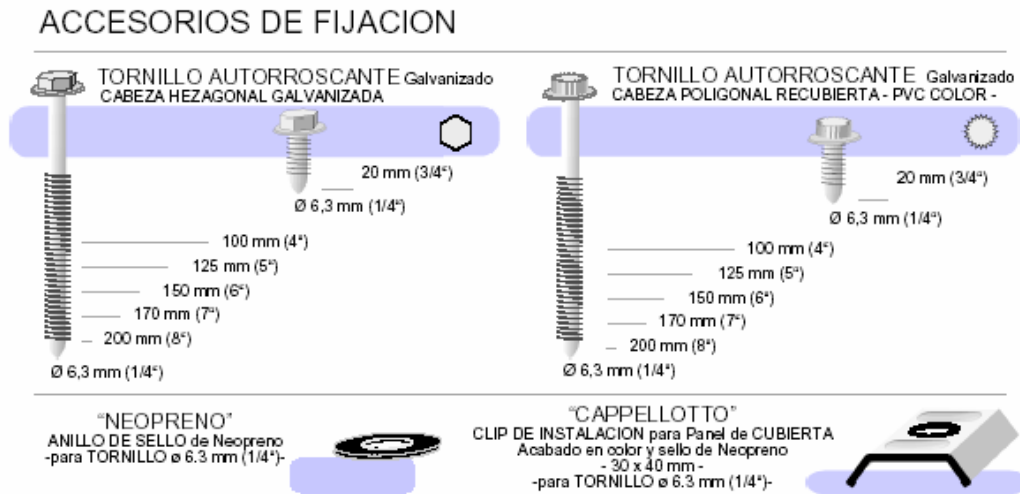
Accesorios de fijación para paneles de muro y cubierta¹
